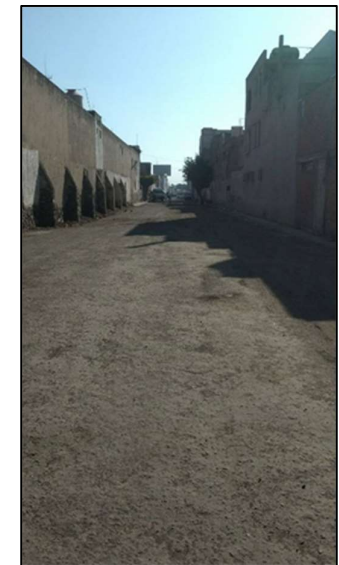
Barda con cara de piedra y columnas, repilladas.
